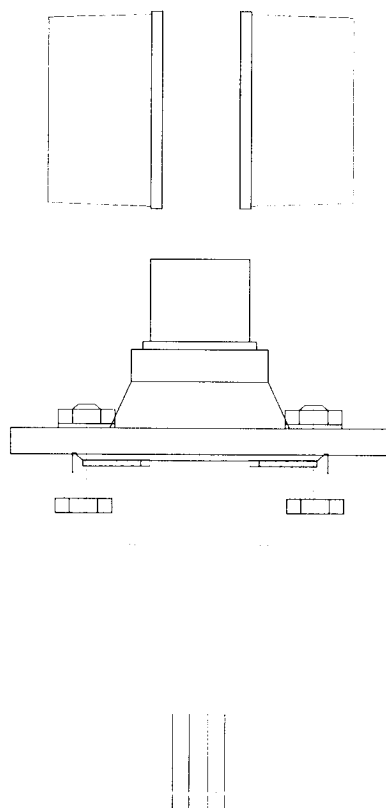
Схема монтажа МИ с приварным фланцем на прямоугольном газоходе
